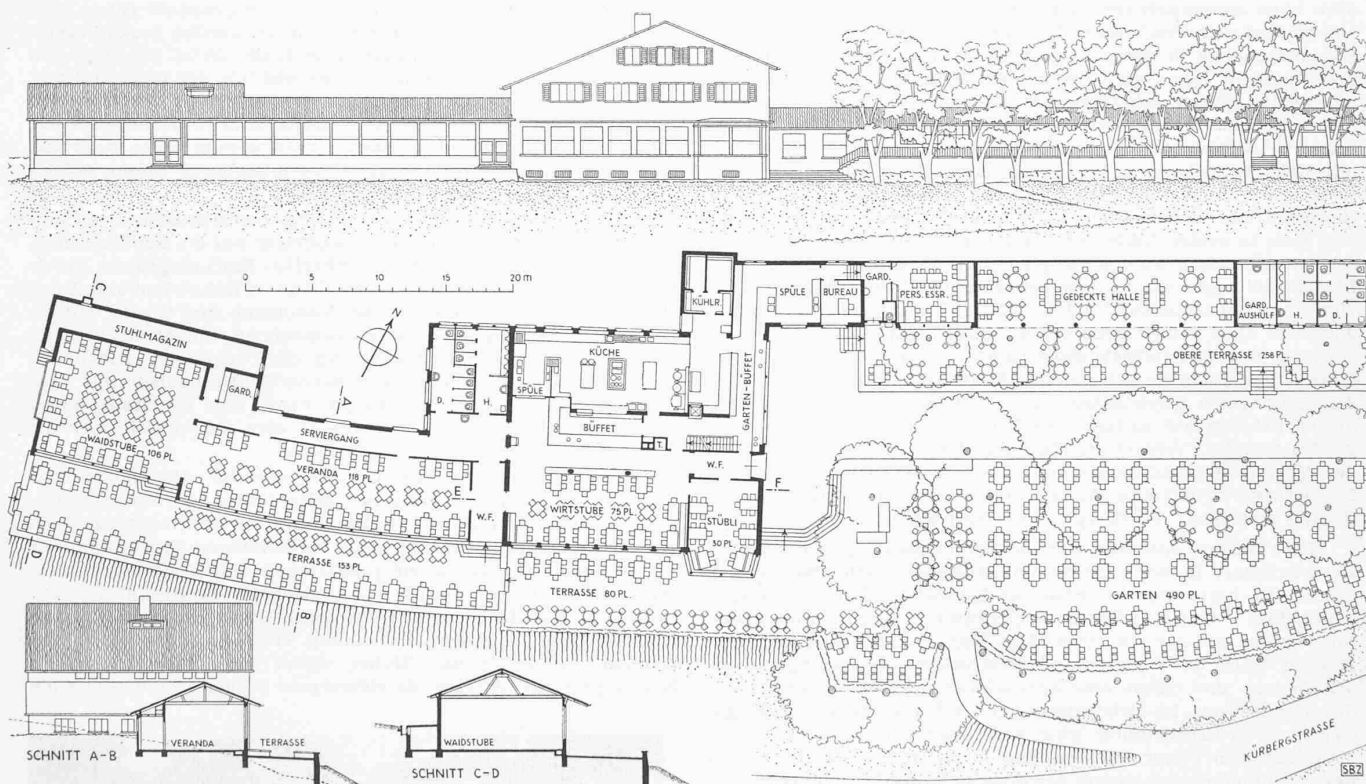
Erdgeschoss-Grundriss mit Lageplan, Schnitte und Gesamtansicht. — Masstab 1 : 500
